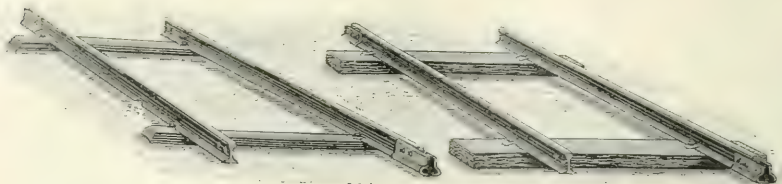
2 m langes bewegliches Joch mit Stahlschwelle.
